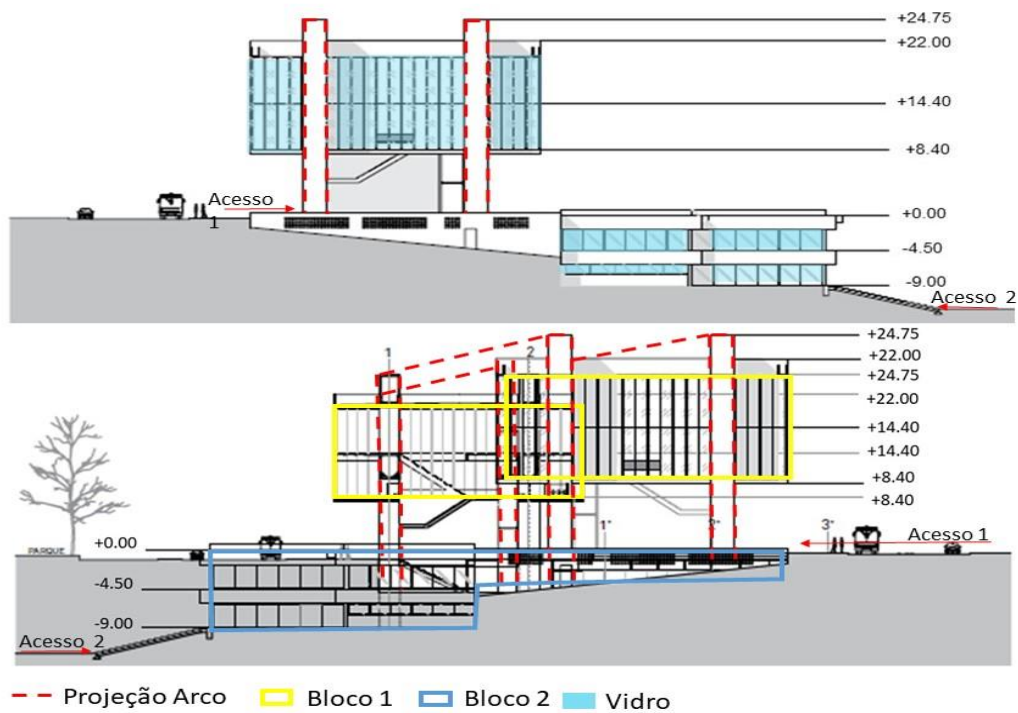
Vista frontal - Avenida Paulista e vista posterior, Rua Carlos Cermenale
